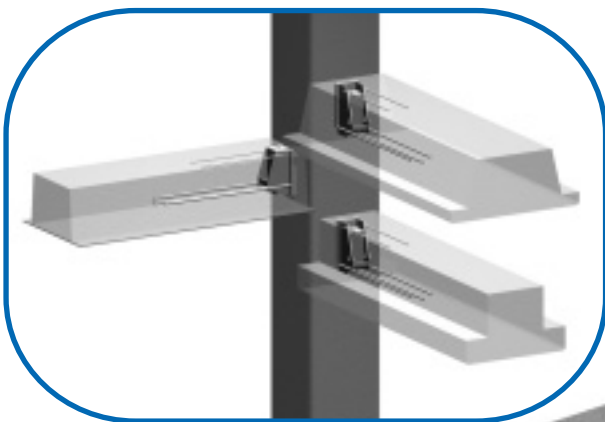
Sistema Peikko® de ménsula PCs - pie de viga PC con viga armada o pretensada
